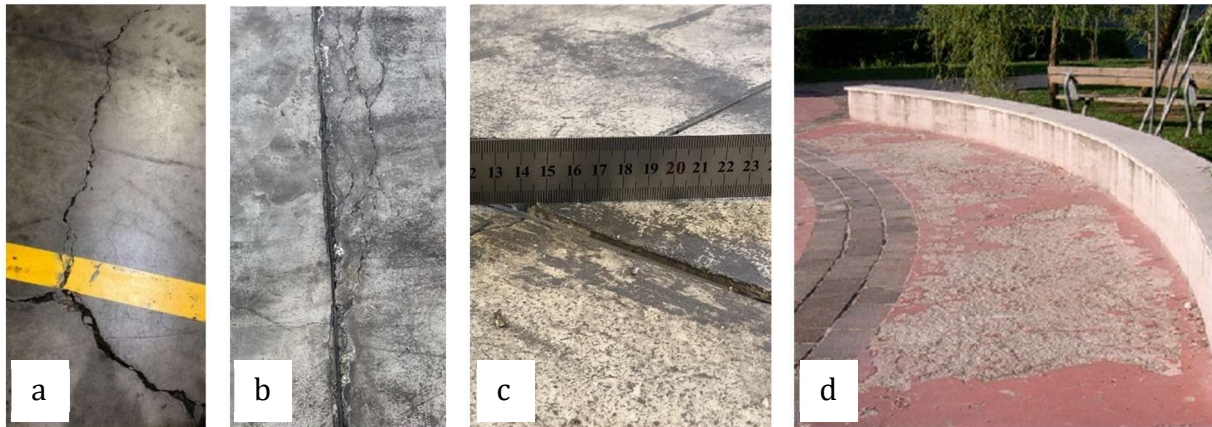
Forme di degrado delle pavimentazioni in calcestruzzo sanabili con il Sistema STRUCTURE PAV
